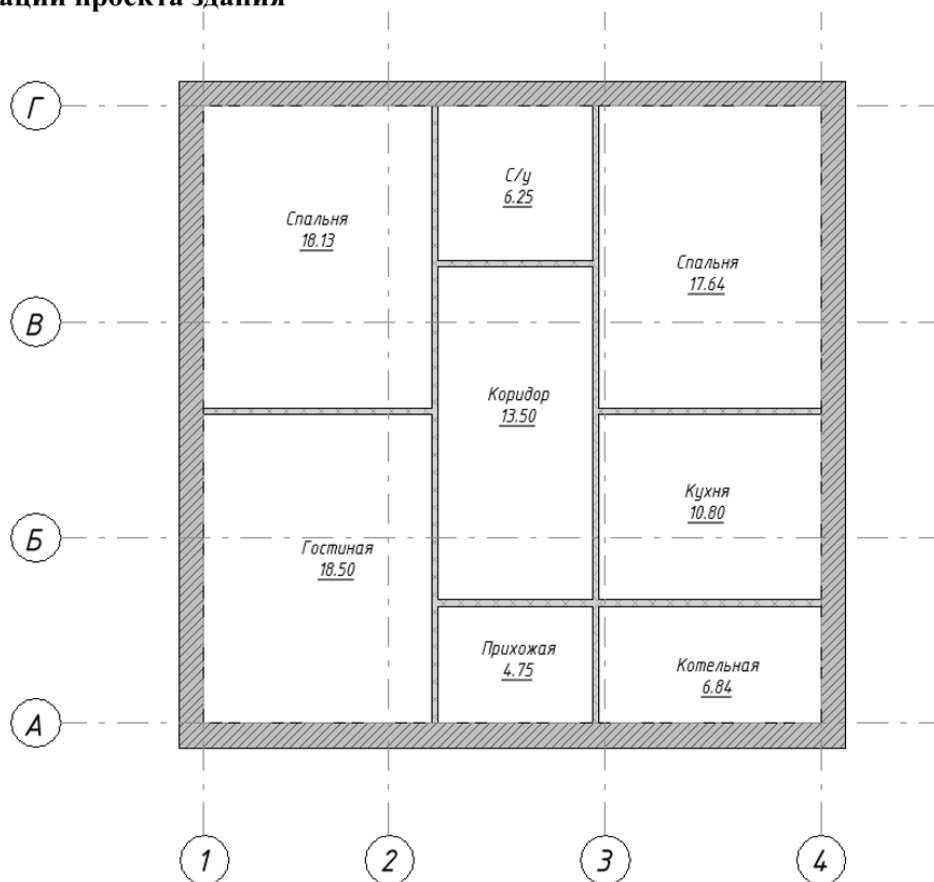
План 1-го этажа малоэтажного жилого здания
